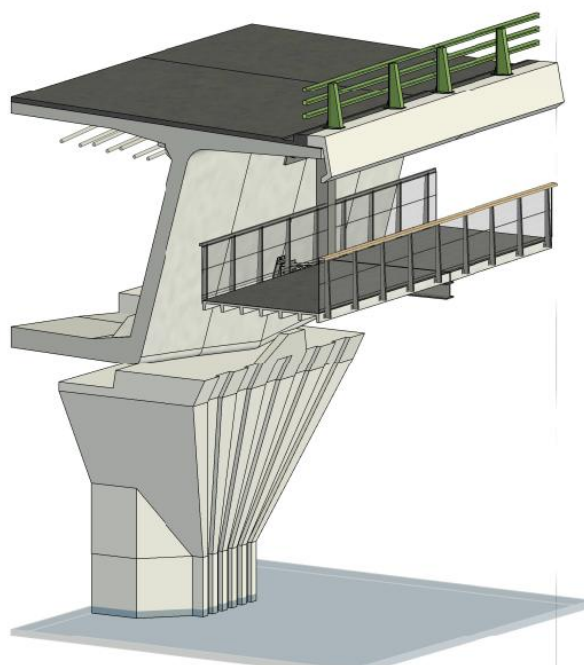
Extrait cahier de plan – Vue d'une console courante avec platelage
